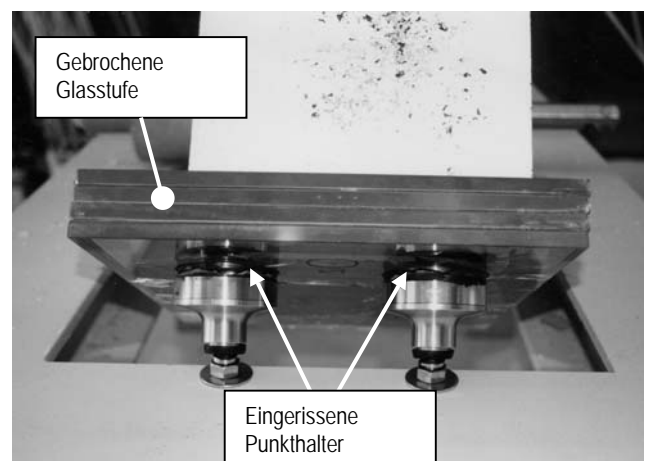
Resttragfähigkeitsuntersuchung an einer Treppenstufe, Glasstufe gebrochen und Punkthalter eingerissen (FHM)
